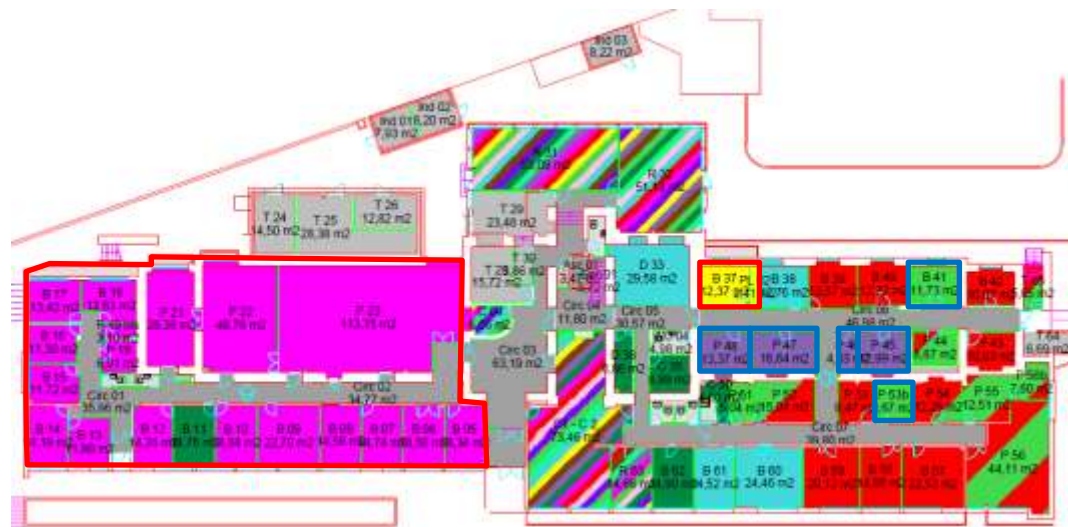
Plan RDC pavillon TAILLEFER – plan d'occupation 2020
